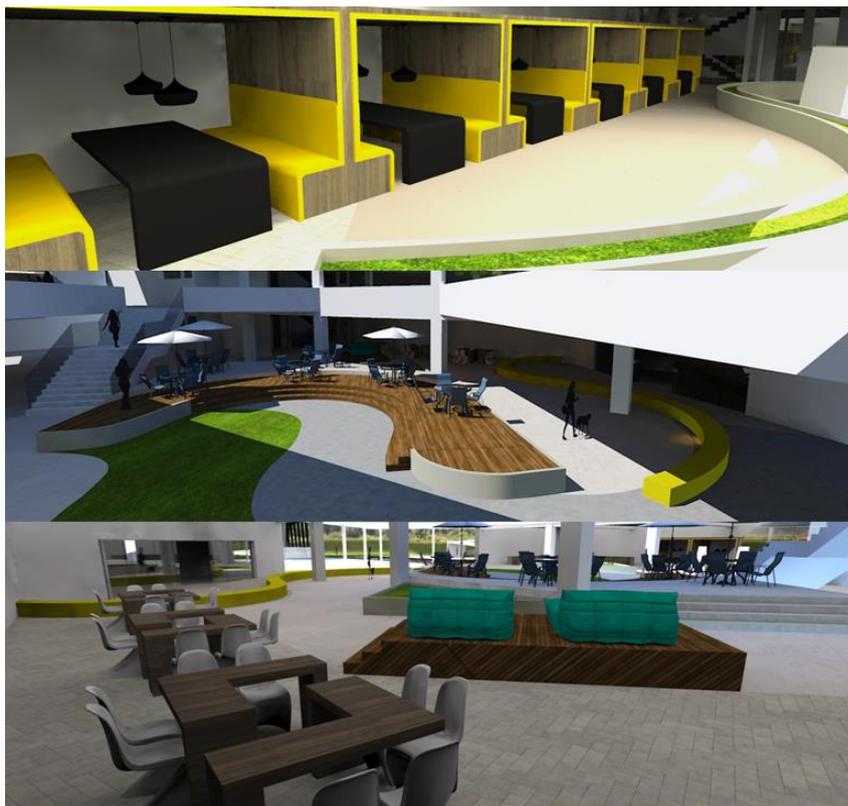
Cabines de estudo, deck no pátio interno e interior do pavimento do subsolo.
